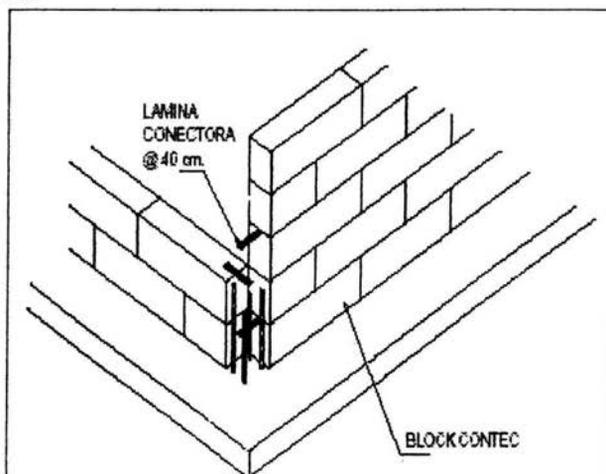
En la figura se muestra la forma correcta construcción de muros en zonas sísmicas, con el fin de asegurar un comportamiento estructural adecuado.
